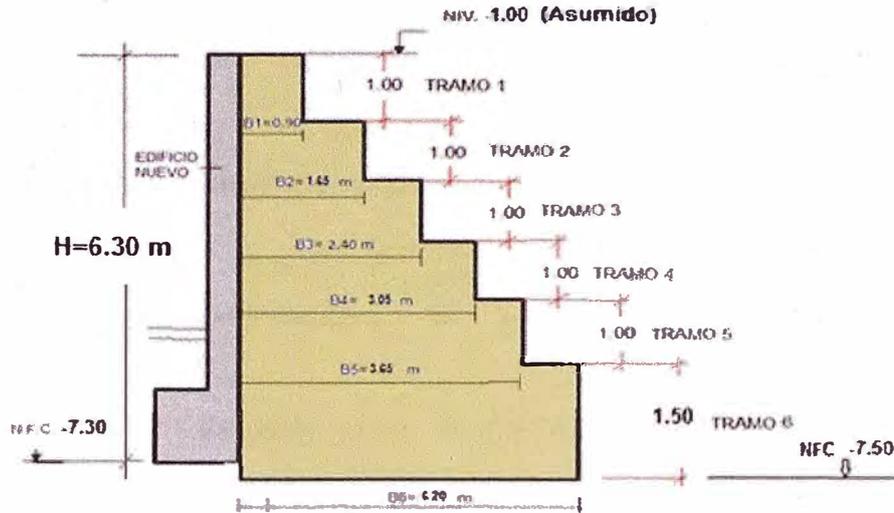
Diseño final de calzaduras (Sección 1-1)
